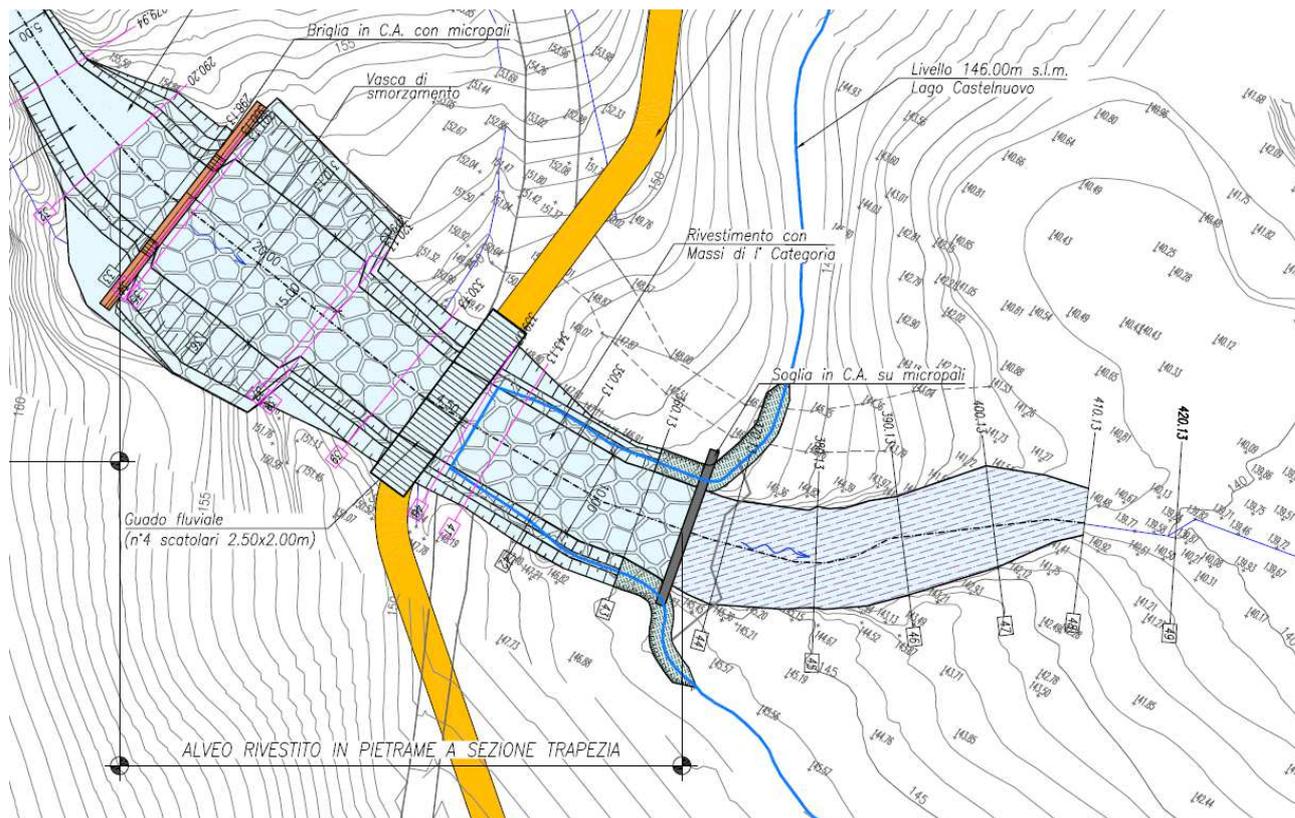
Planimetria Tavola 3/3 – Borro Pianale
